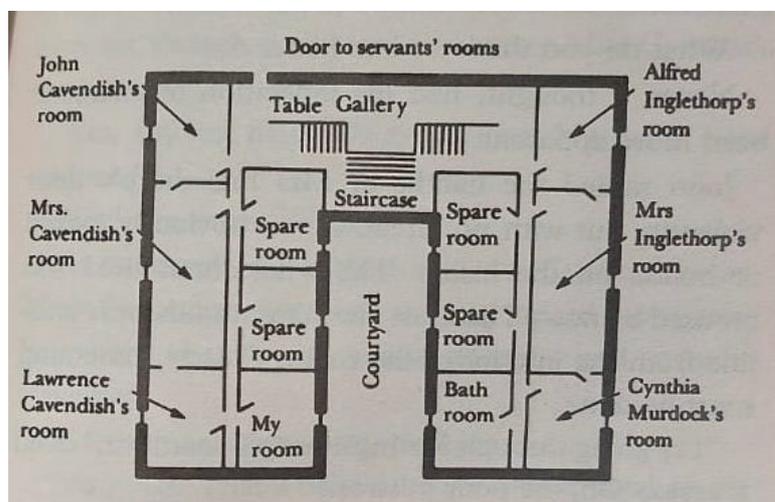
Planta do primeiro andar da Mansão Styles<sup>91</sup>.
